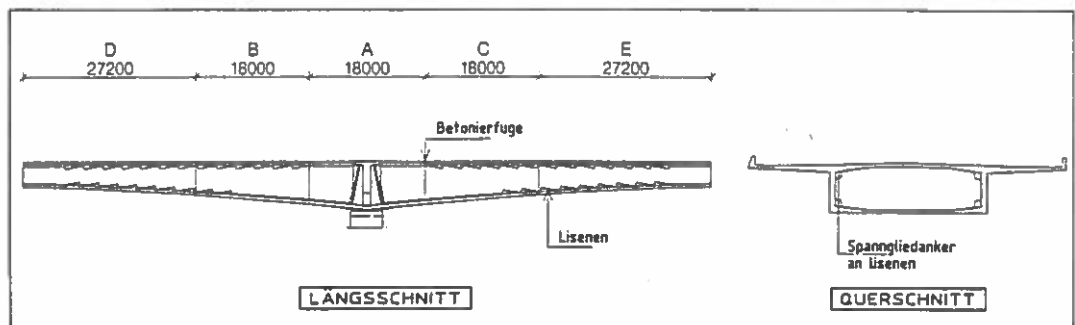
Typischer Längsschnitt eines Trägers mit Betonierfugen
